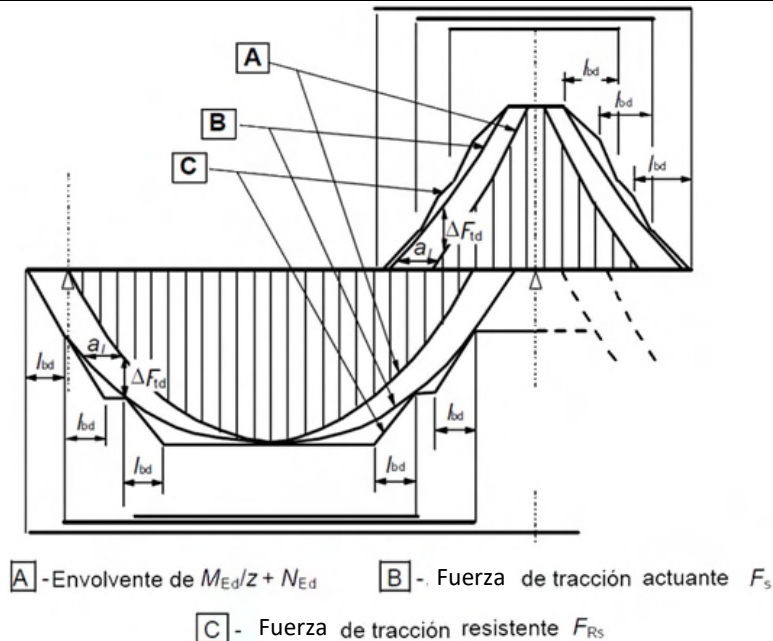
Imagen del decalaje de la armadura longitudinal, teniendo en cuenta el efecto de las fisuras inclinadas y la resistencia de la armadura en la longitud de anclaje
